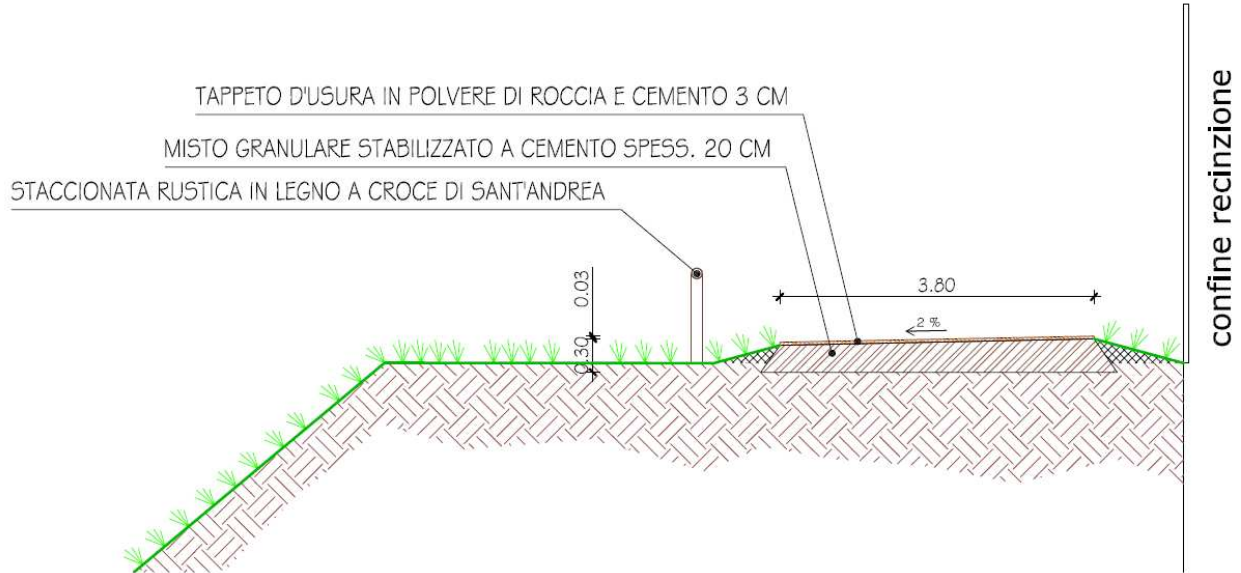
Sezione tipo della pista ciclabile con cassonetto stradale
